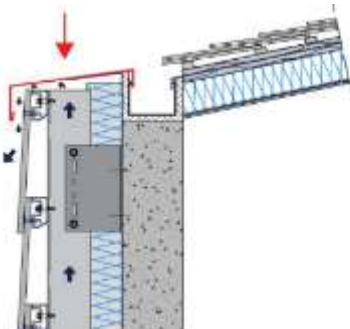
facade ventilée schema de tôle métallique d'acrotère
